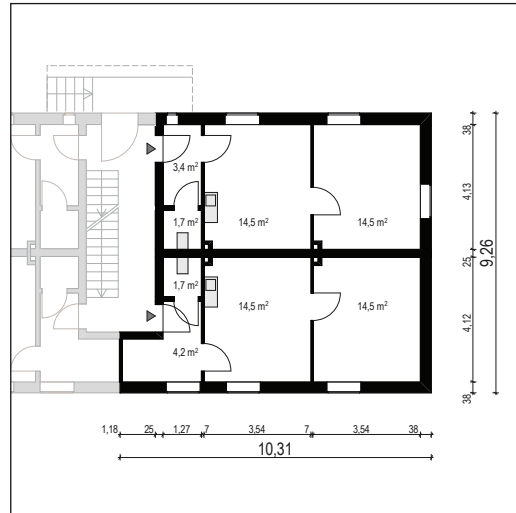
Beispielgrundriss Ingolstadt, Hindemithstraße 5
